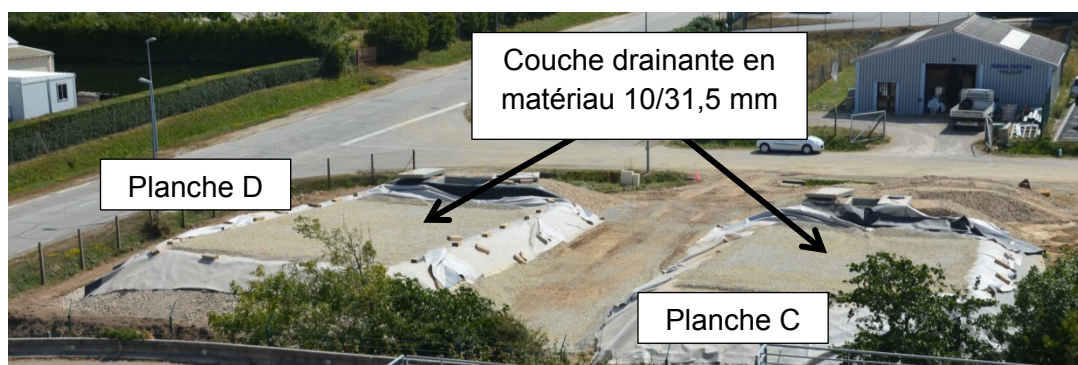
Photographie de la couche drainante de 20 cm en matériau 10/31,5 mm des planches d'essais C et D
